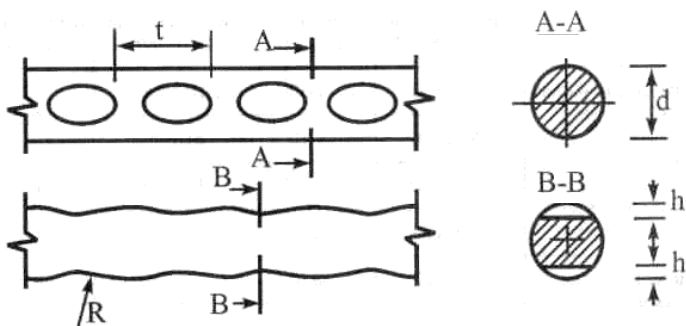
Периодический профиль высокопрочной арматурной проволоки
